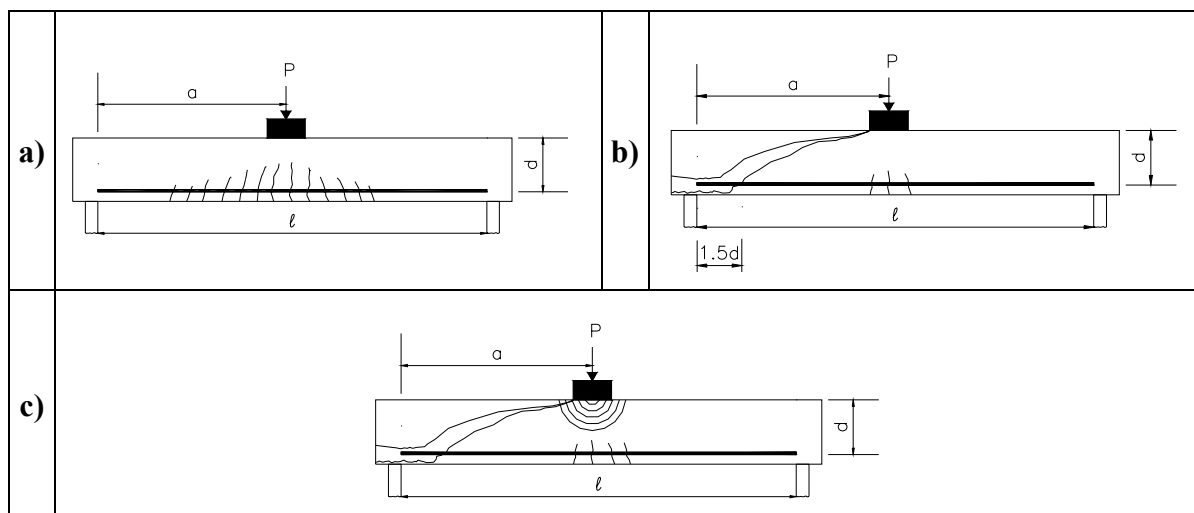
Tipos de ruptura de vigas de concreto armado sem armadura transversal. (SANCHES, 1999)
